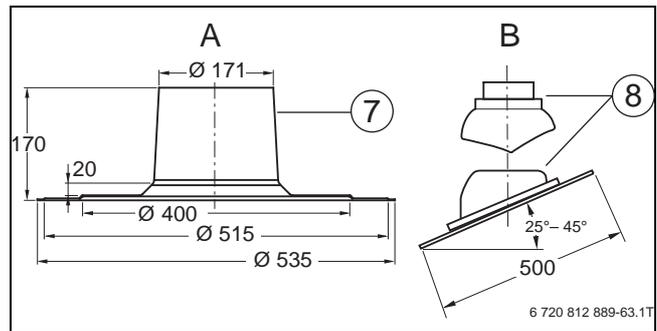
Universaldachpfannen und Flachdach-Klebeflansch als Zusatzausstattung für den Grundbausatz DO (unbedingt mitbestellen); (Maße in mm)
